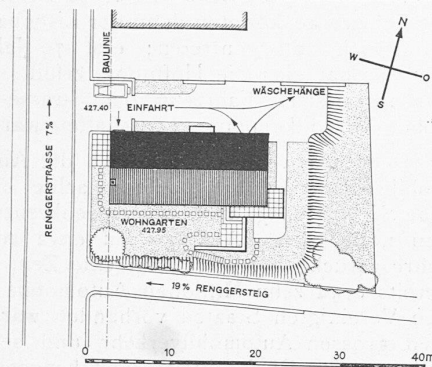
Lageplan des Arzthauses. — 1 : 800.
